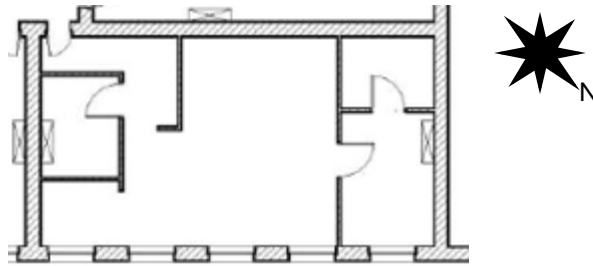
Détail de plan montrant le logement Ouest de la façade Nord-Ouest [33]
